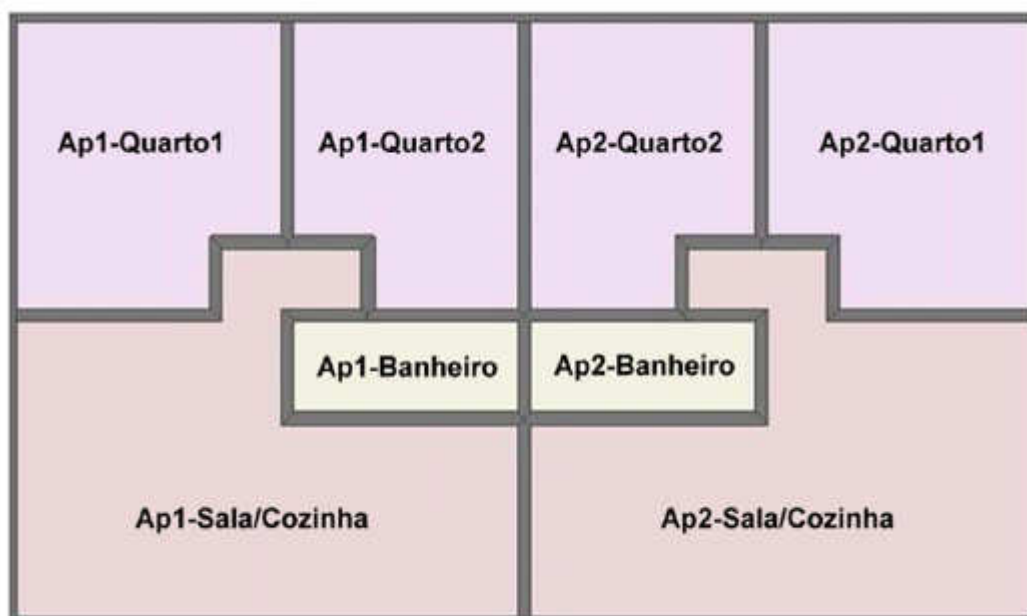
Planta baixa (simplificada) com módulo espelhado.
